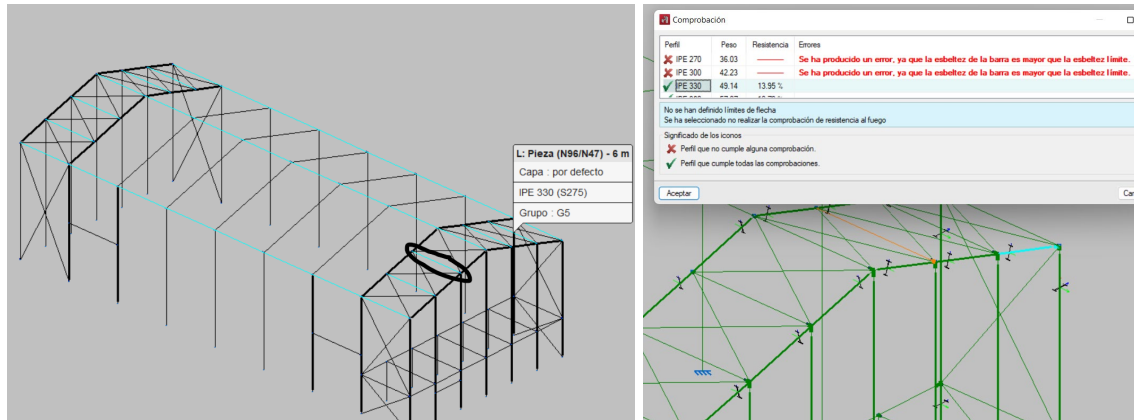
Evaluación de perfiles para la viga de atado más desfavorable
